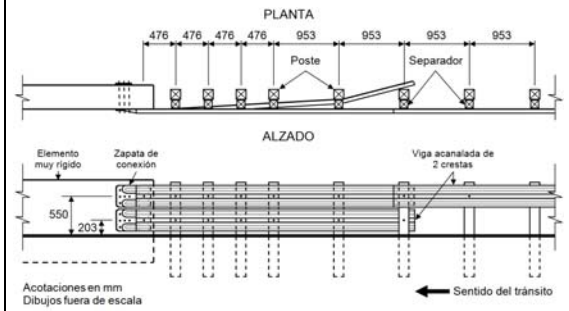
Transición de barrera metálica de doble banda a muro vertical recto
